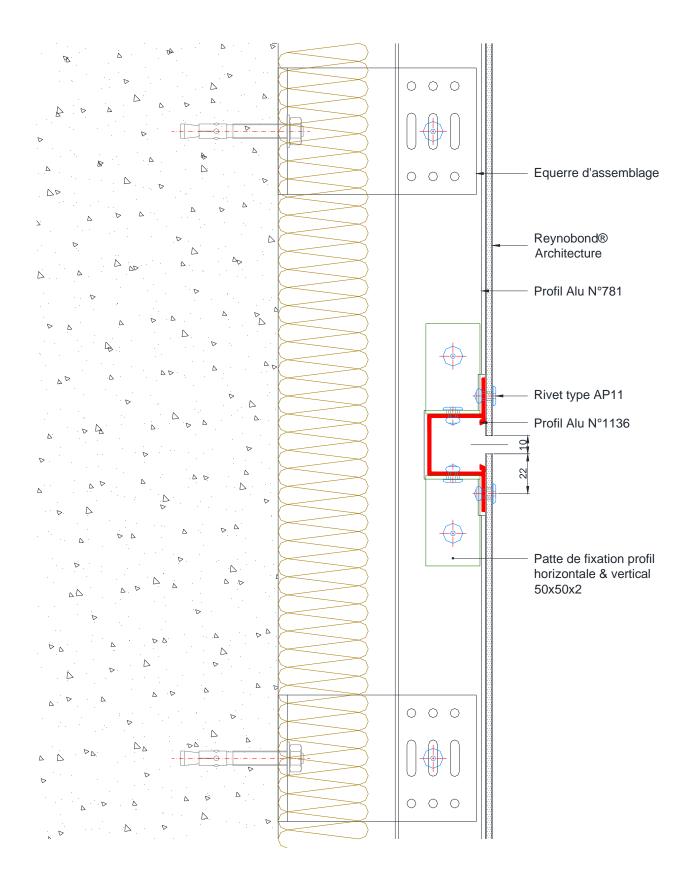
is – Joint horizontal - Coupe verticale – Système vissé SC 50 4c
